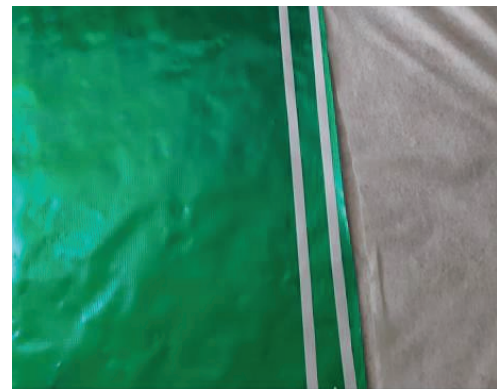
Detalle de capa separadora y unión de la barrera de protección.
